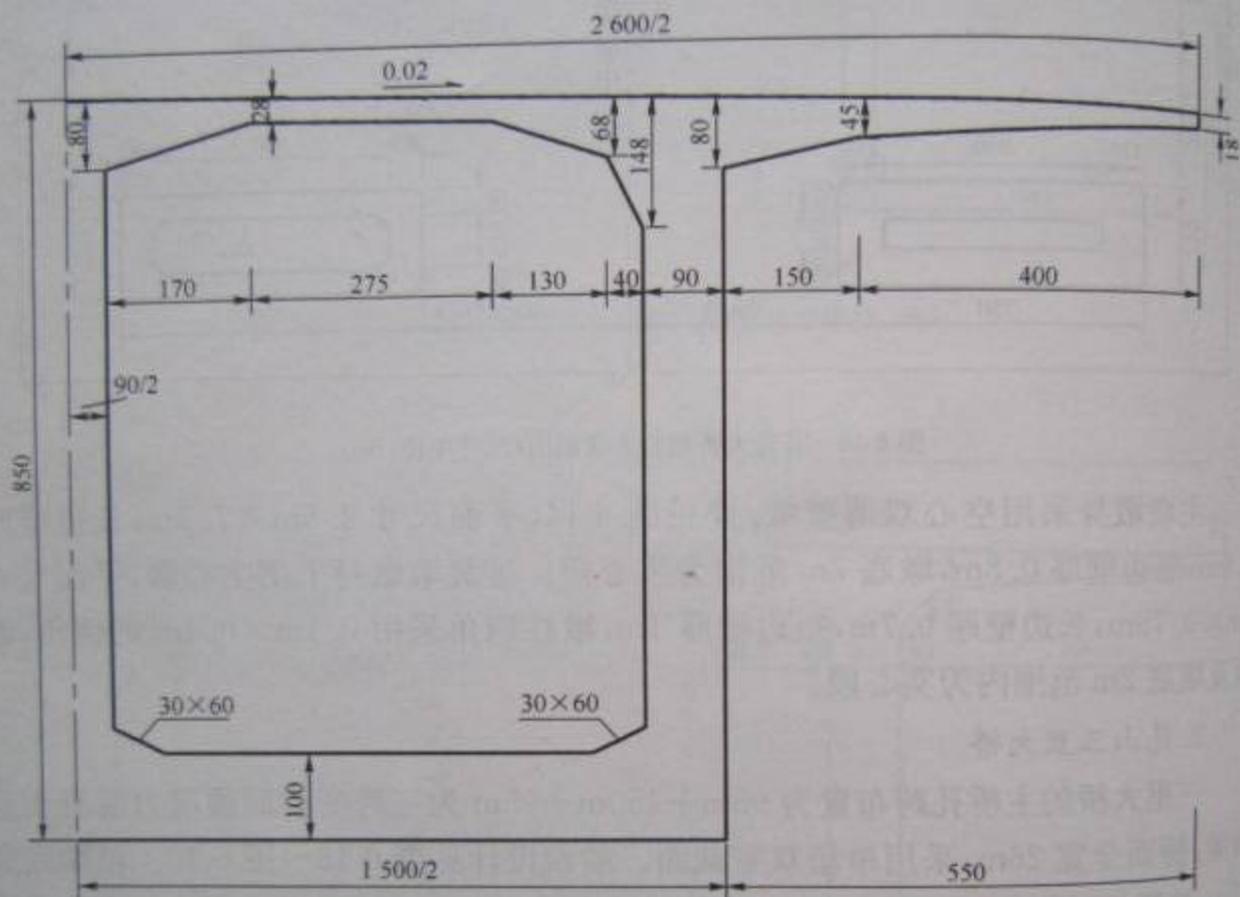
三里大桥主桥箱梁根部截面(尺寸单位:cm)
